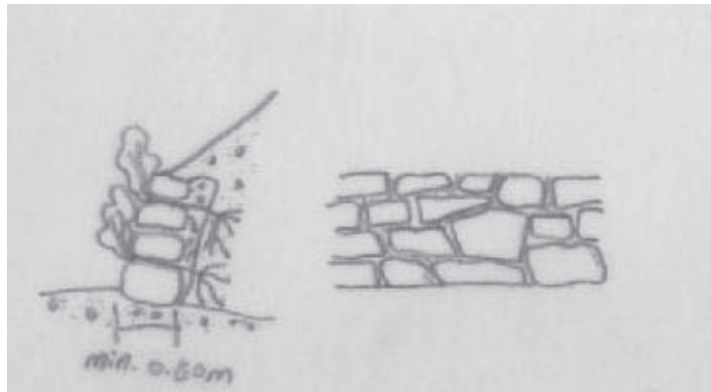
Sistema constructivo de u muro de piedra; dibujo realizado por Salvador Díaz P.
